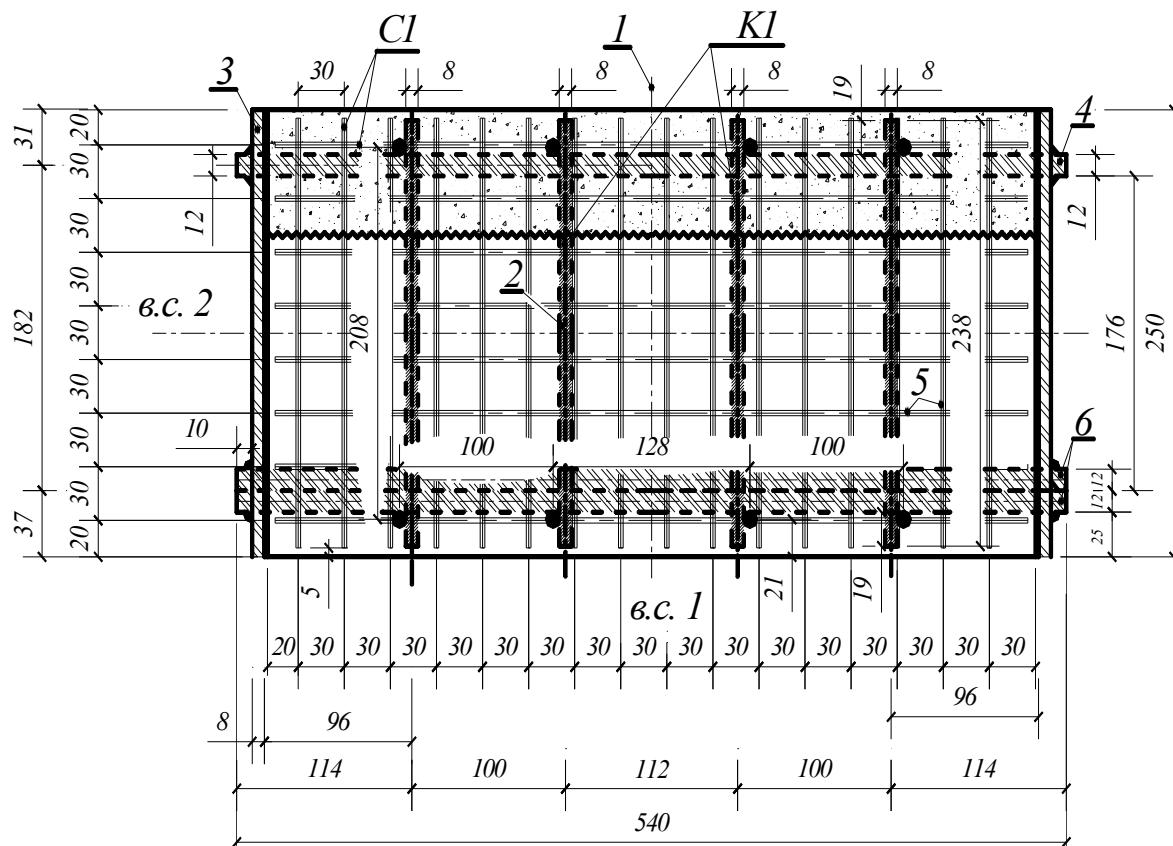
Конструкція експериментальних залізобетонних складених балок-стінок: 1 – вертикальна вісь симетрії зразка; 2 – поперечна арматура діаметром 8мм, класу A240C; 3 – пластина, товщиною 8мм, приварена до повздовжньої робочої арматури; 4 – повздовжня арматура, розташована у верхній частині балки-стінки, діаметром 12мм, класу A500C; 5 – арматурні сітки діаметром 3мм, з розмірами комірки 30×30мм; 6 – повздовжня арматура, розташована у нижній частині балки-стінки, діаметром 12мм, класу A500C
